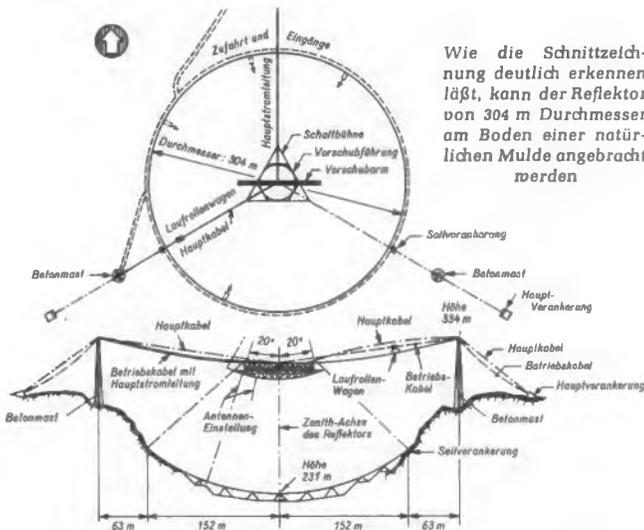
Grundriß und Aufriß des 304-m-Radioteleskop auf Puerto Rico mit allen Abmessungen
